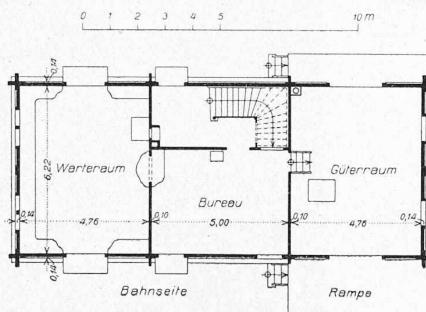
und 5. Typus der Zwischenstationen Ilanz-Disentis. — Grundrisse 1:250.
